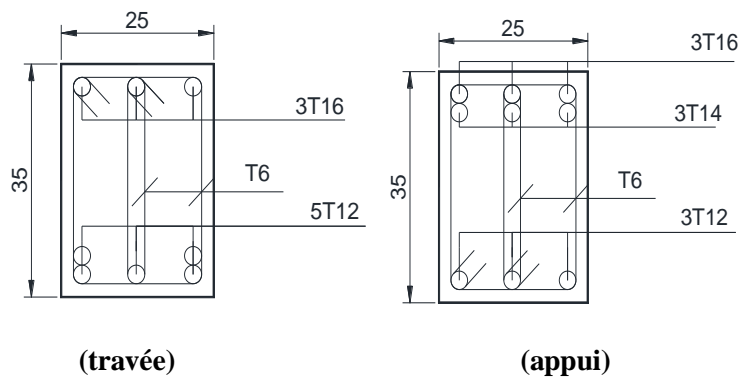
Ferrailage d'une poutre principale 25x35cm (plancher au dalles pleines)
